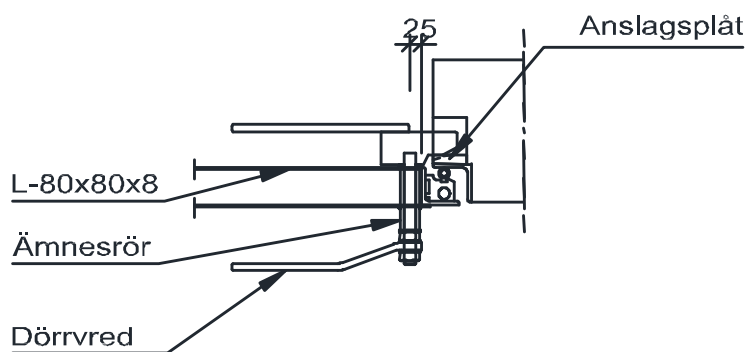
Vy av monterat dörrblad utan betongfyllning
